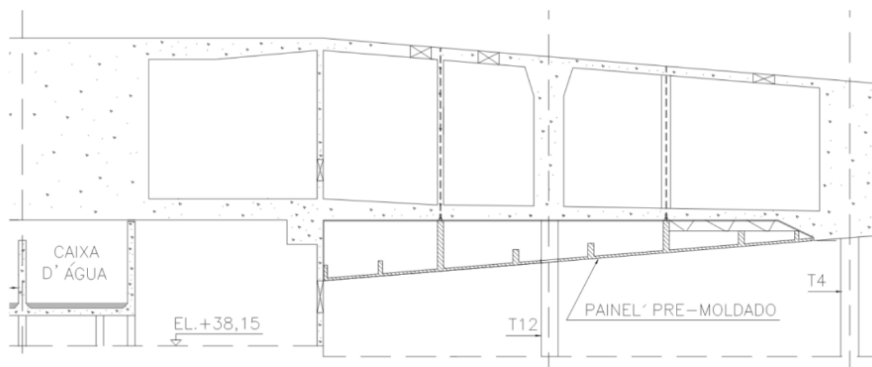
Detalhe em corte de uma viga protendida de seção variável, bloco A.
